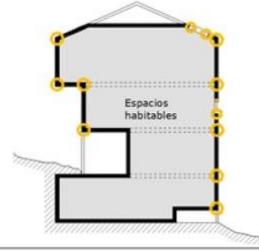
Análisis Pilar Integrado en Fachada. Muro de Fachada Norte. CE3X.
